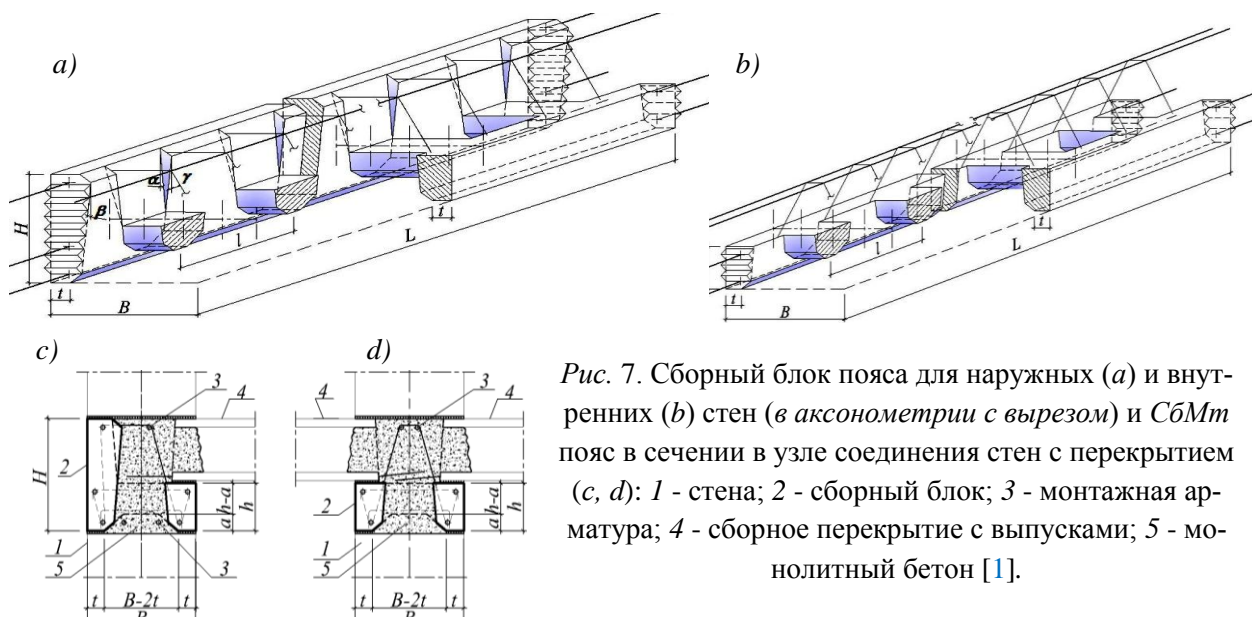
Сборный блок пояса для наружных (а) и внутренних (b) стен (в аксонометрии с вырезом) и СбМт пояс в сечении в узле соединения стен с перекрытием (с, d): 1 - стена; 2 - сборный блок; 3 - монтажная арматура; 4 - сборное перекрытие с выпусками; 5 - монолитный бетон [1].
